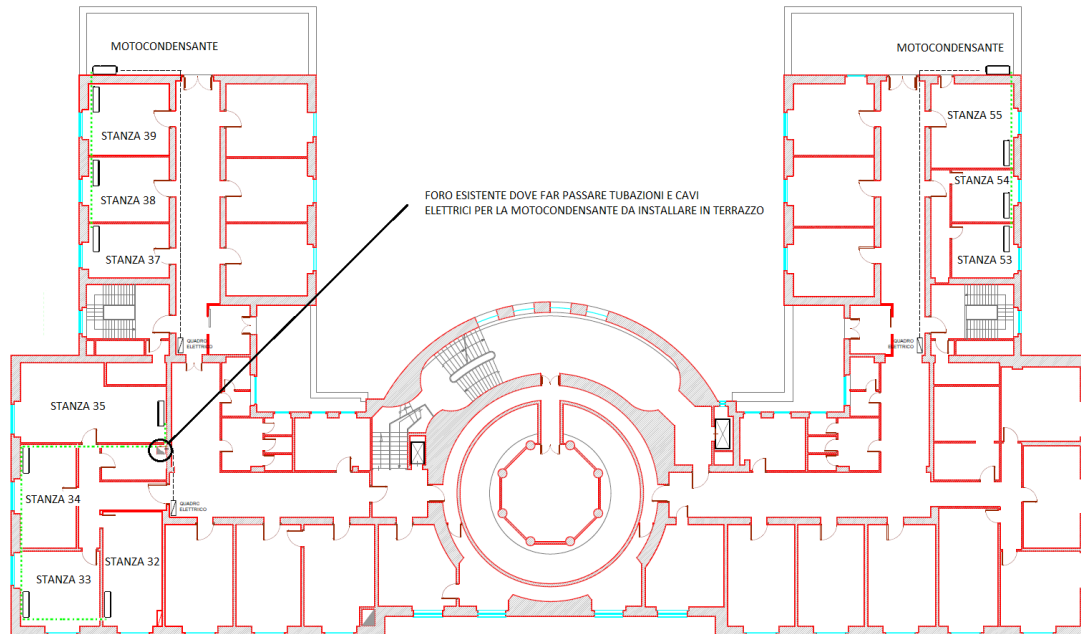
Primo piano edificio principale con stanze interessate dai lavori.
